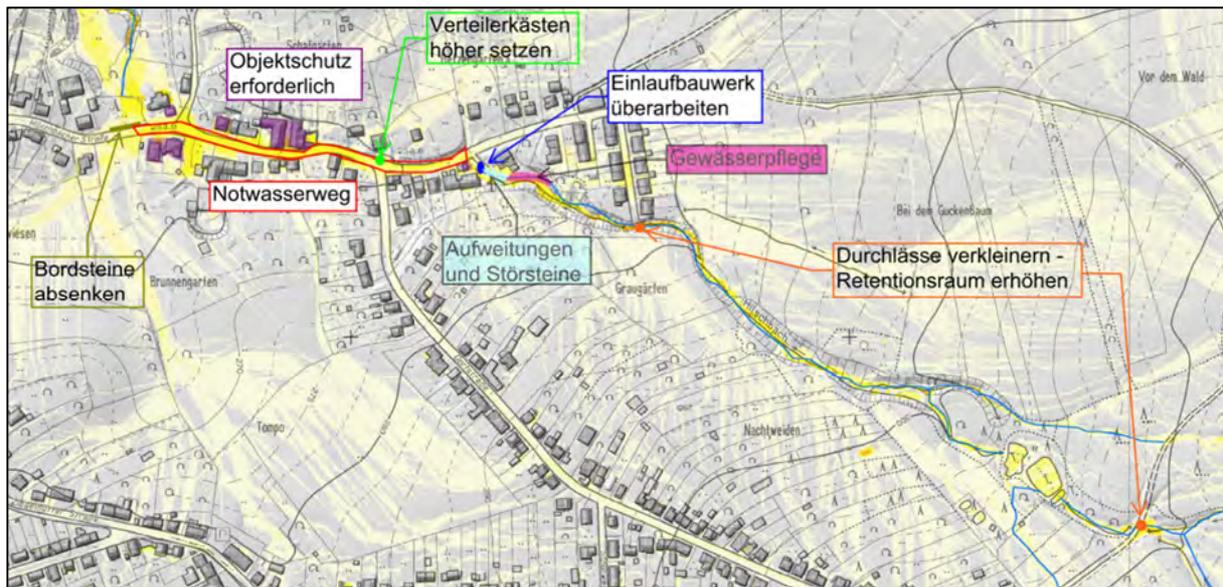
Lageplan Maßnahmenvorschläge Hilschbach
